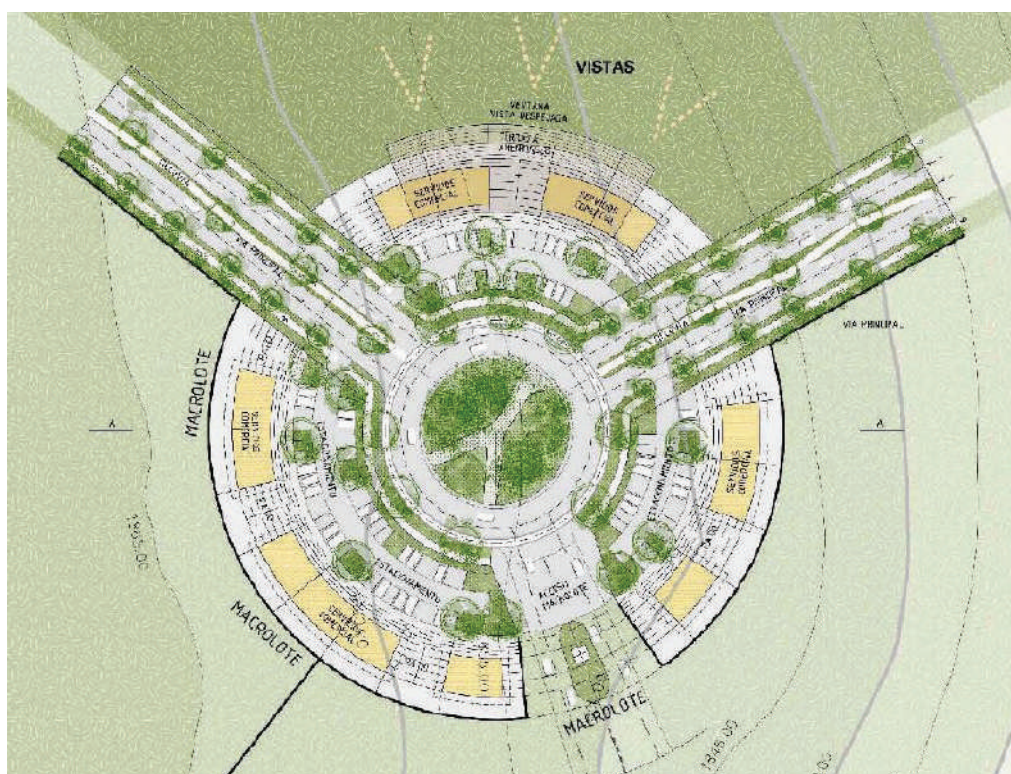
Vista en planta del área comercial. Fuente: Máster Plan Centauro.
